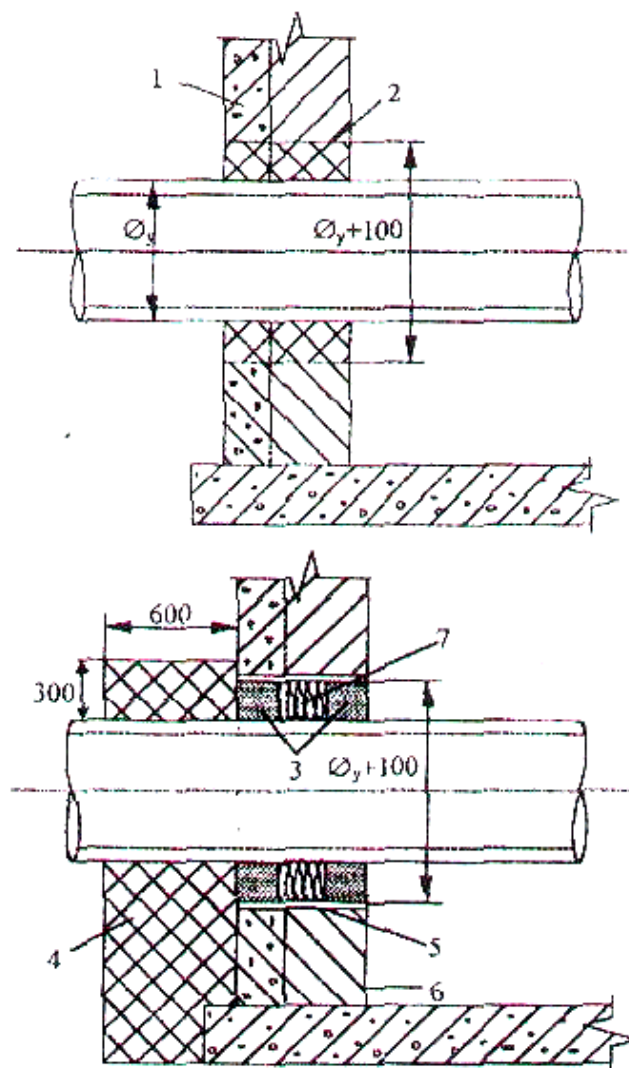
Способы соединения подземных трубопроводов с колодцами:
